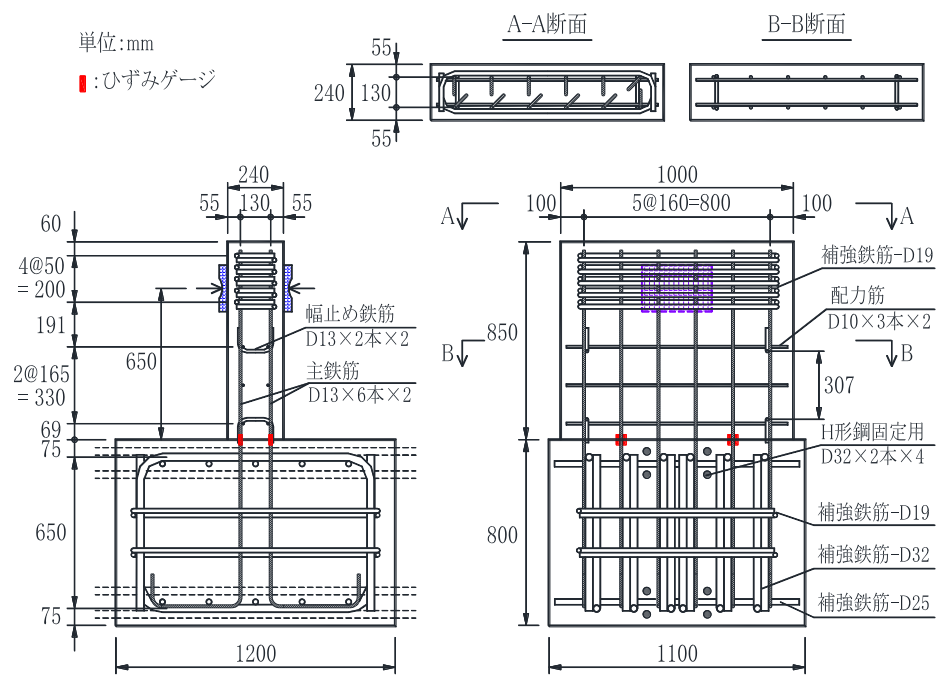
試験体の形状寸法と配筋 (ND13A, ND13B)
